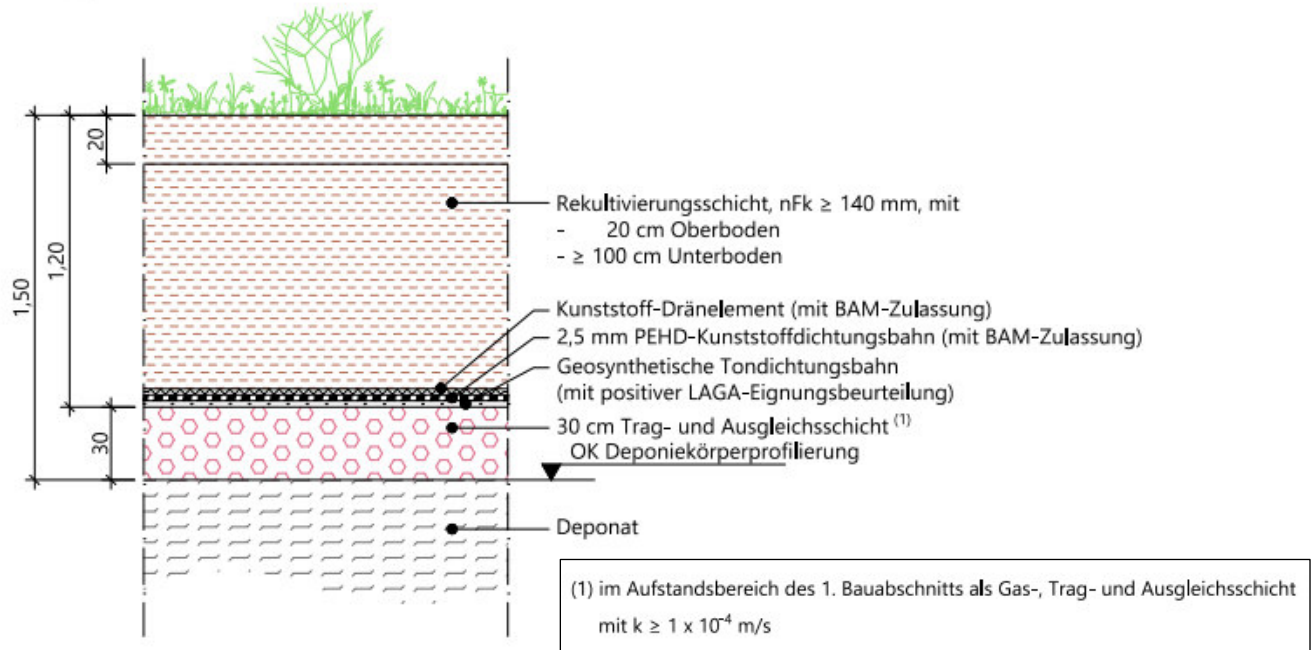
Detaildarstellung Oberflächenabdichtungssystem (Quelle: Bestandslageplan 3182GP405 [92])
